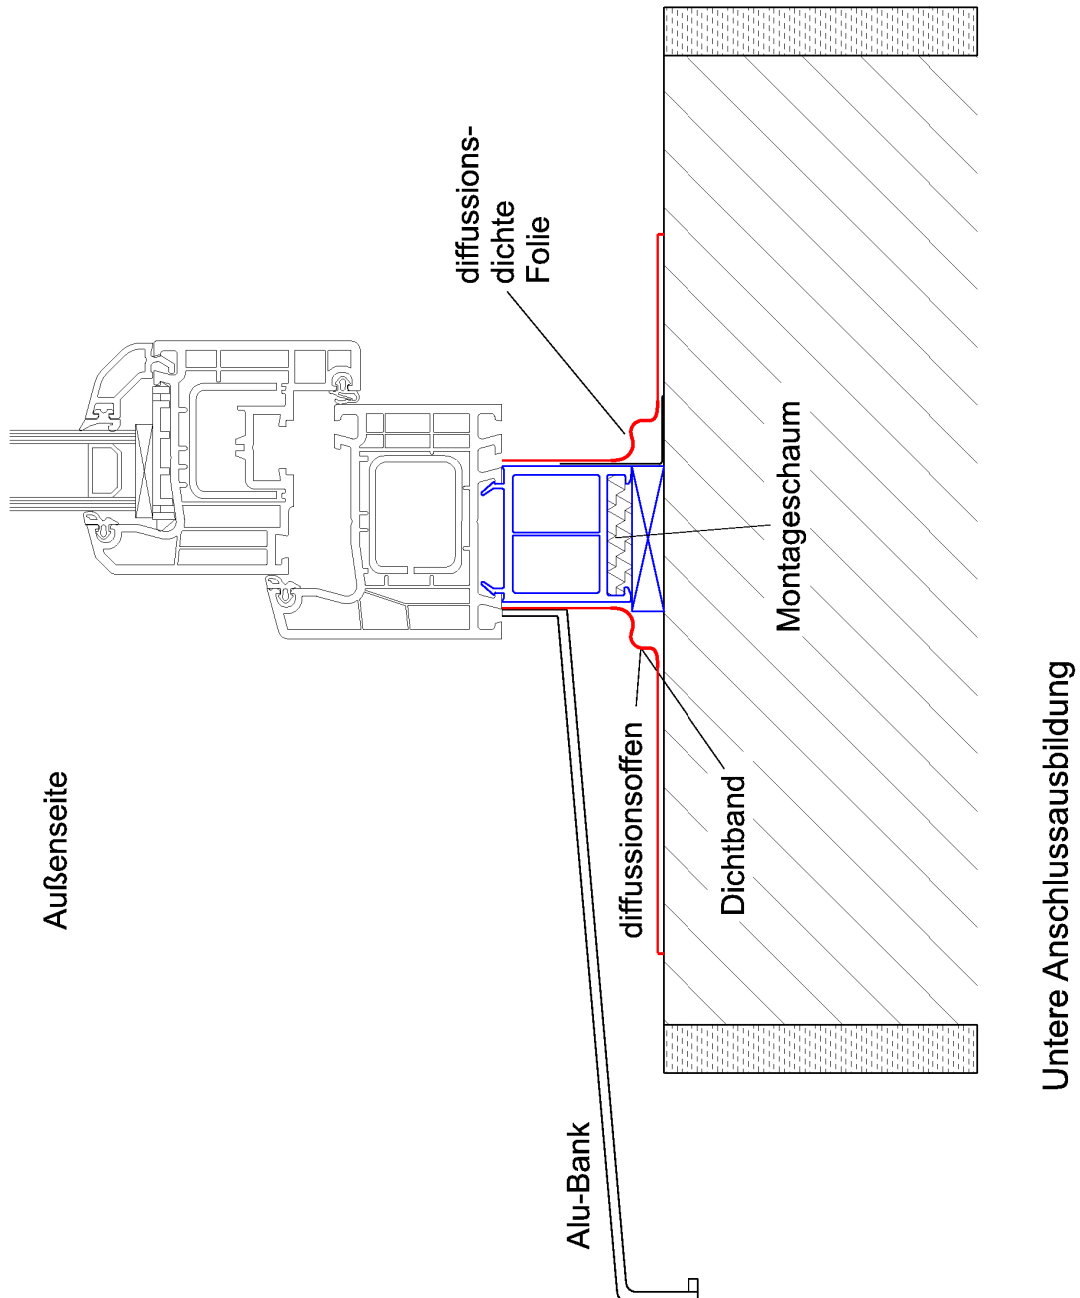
Untere Anschlussausbildung, Brüstung mit Glattstrich ausgeführt.
